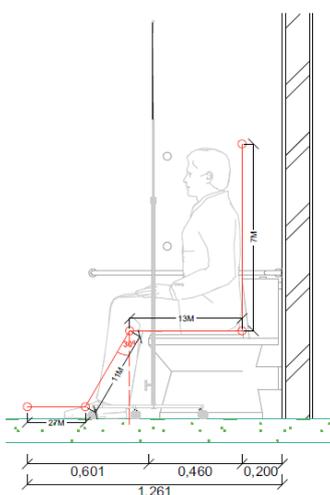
Ruang Gerak Zona Toilet pada Desain
